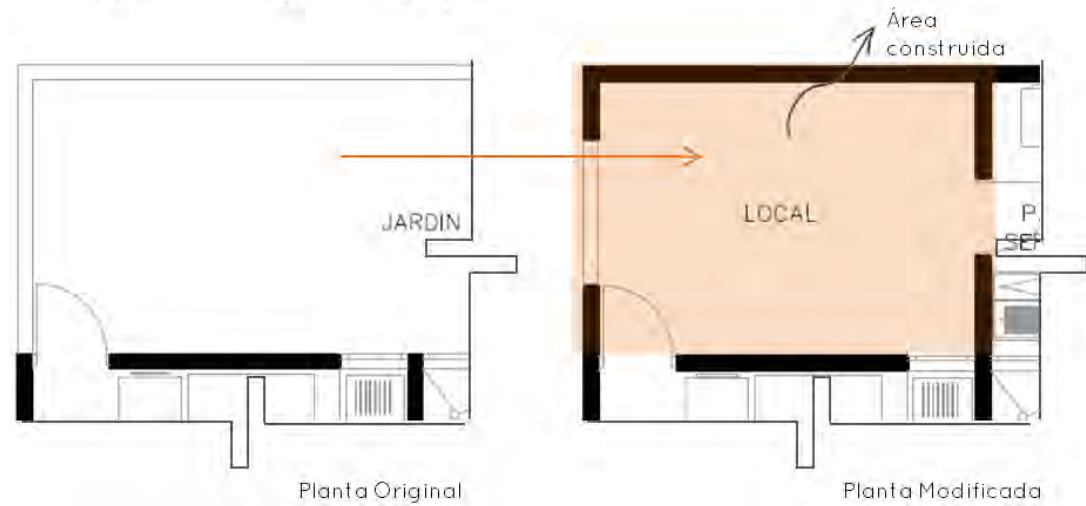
Planta actual comparada con la original, indicando el área donde se construyó el local comercial.
